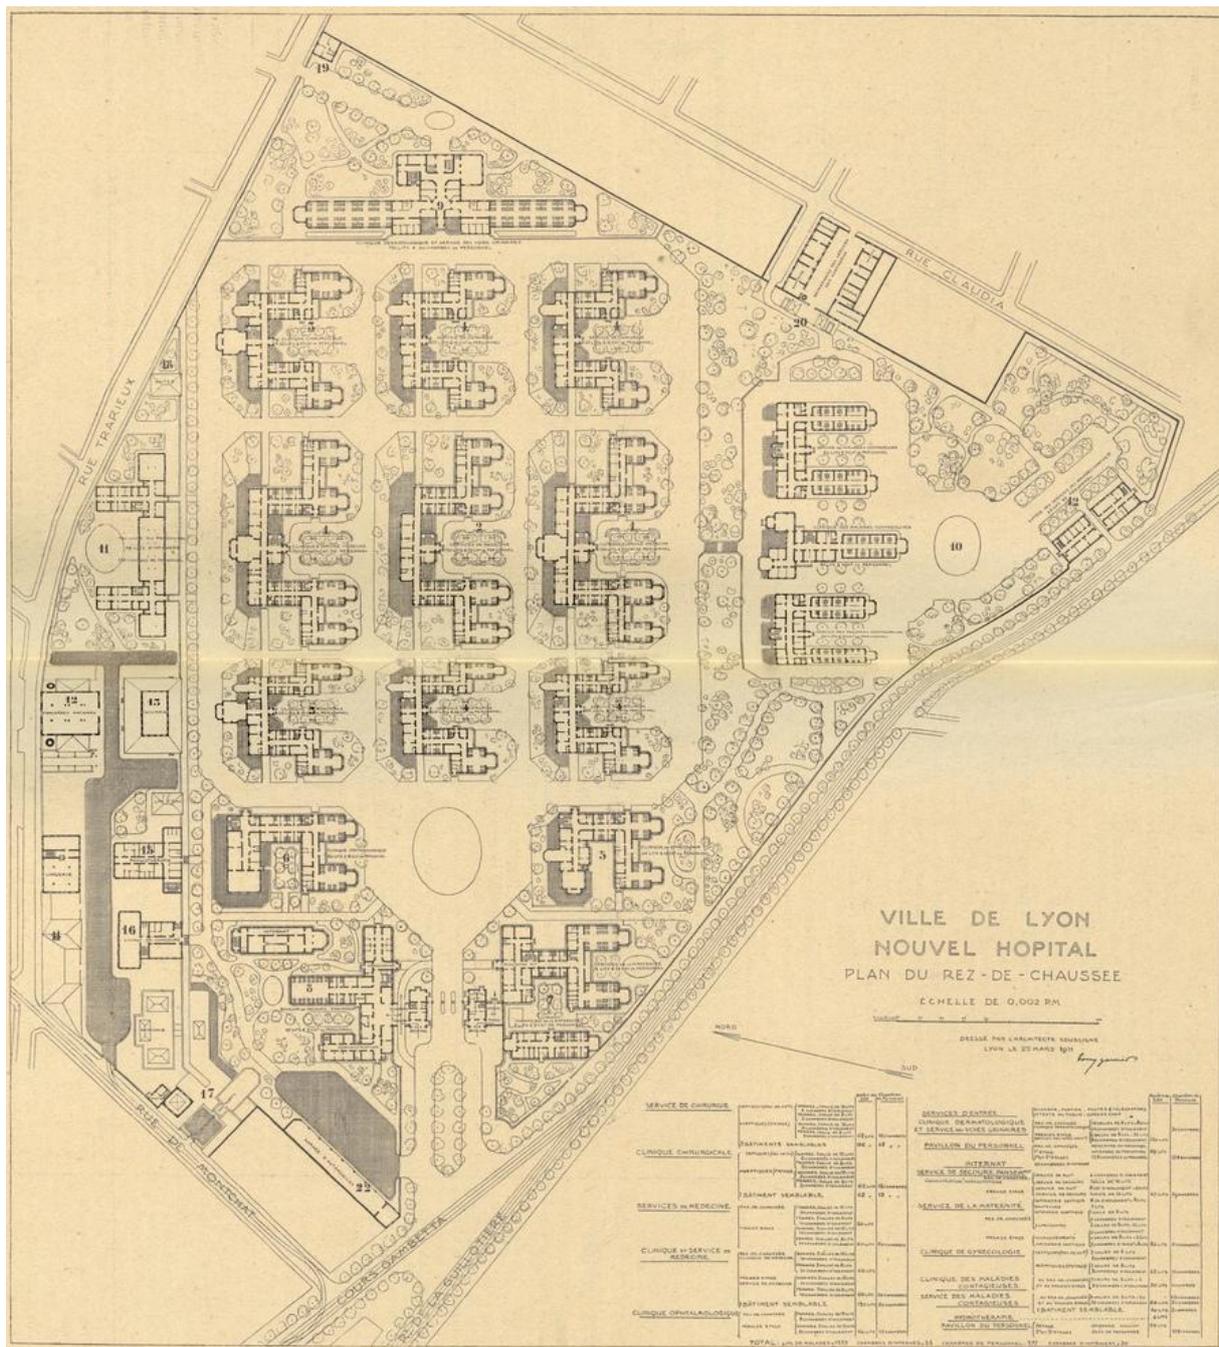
Tony Garnier, *Nouvel hôpital*, plan du rez-de-chaussée, 23 mars 1911. Arch. mun. Lyon. 1 S 156.
